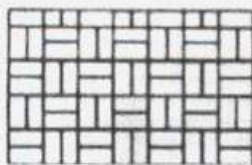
Assentamento tipo trama - Associação Brasileira de Cimento Portland. Pavimento Intertravado
